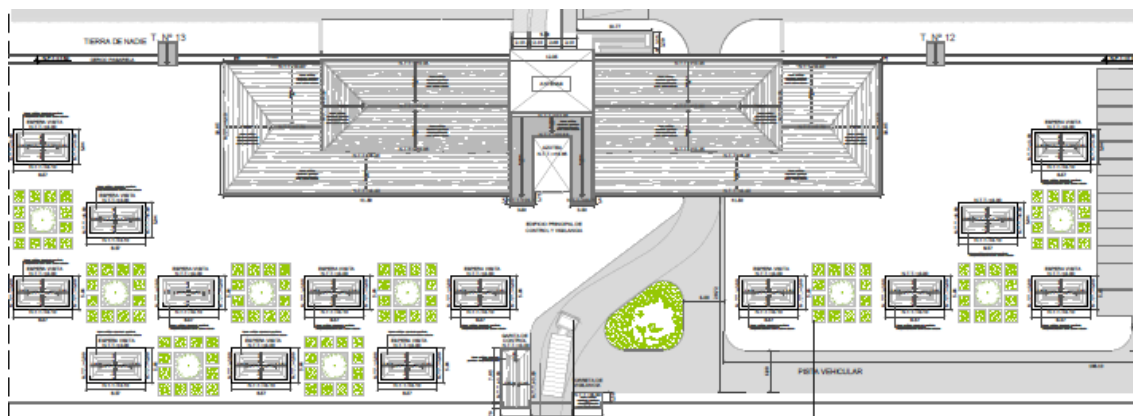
Plantas de la villa INPE tipo 2 de la zona E
